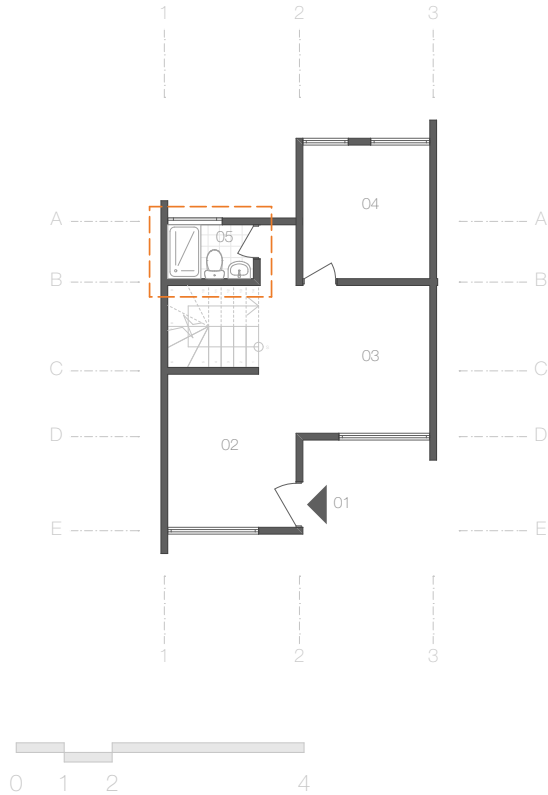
Conjunto Habitacional Tarqui Planta Baja
